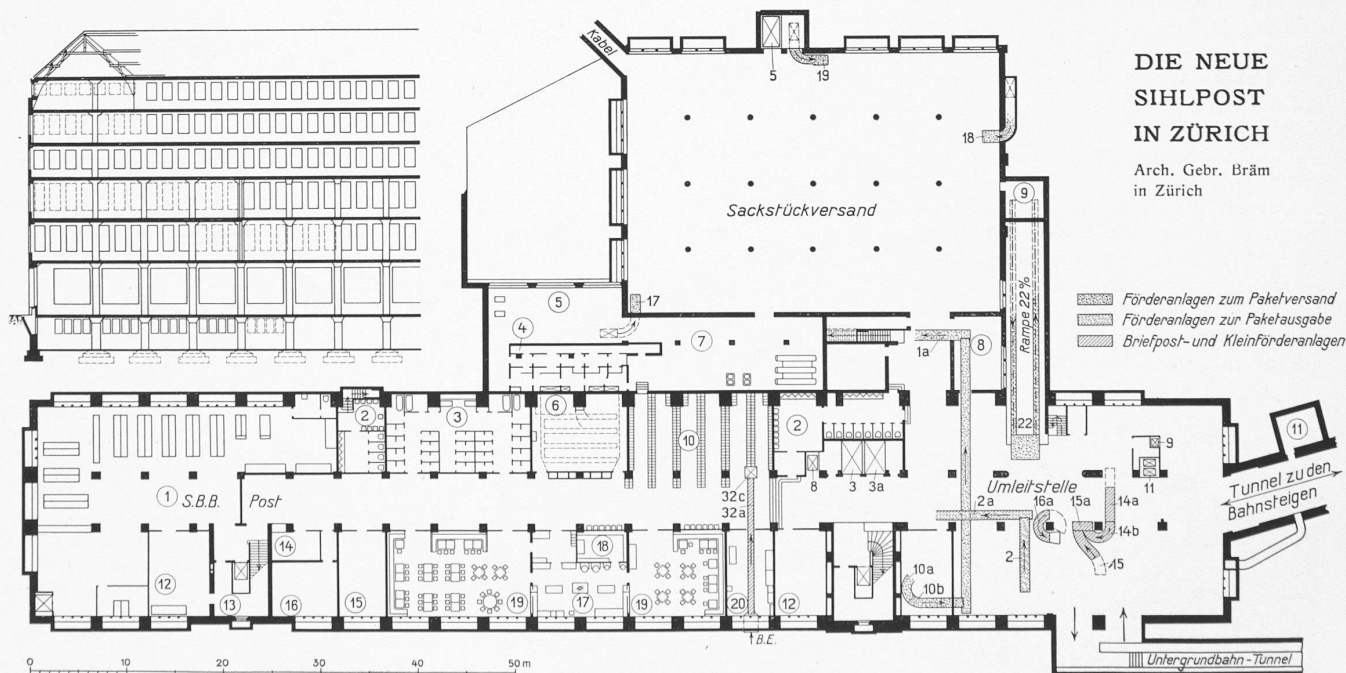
Grundriss vom Untergeschoss des Hauptgebäudes und des Paketversands; links Teilängsschnitt. — Masstab 1 : 700.
